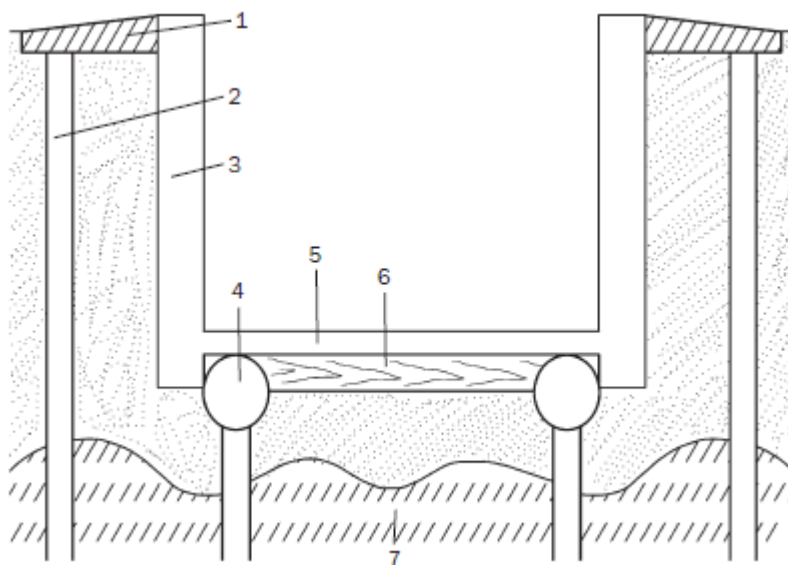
Создание внешнего дренажа для подвала: 1 – отмостка; 2 – дренажные трубы; 3 – стены подвала; 4 – дренажные траншеи; 5 – пол подвала; 6 – щебеночная подушка; 7 – материковые пески
